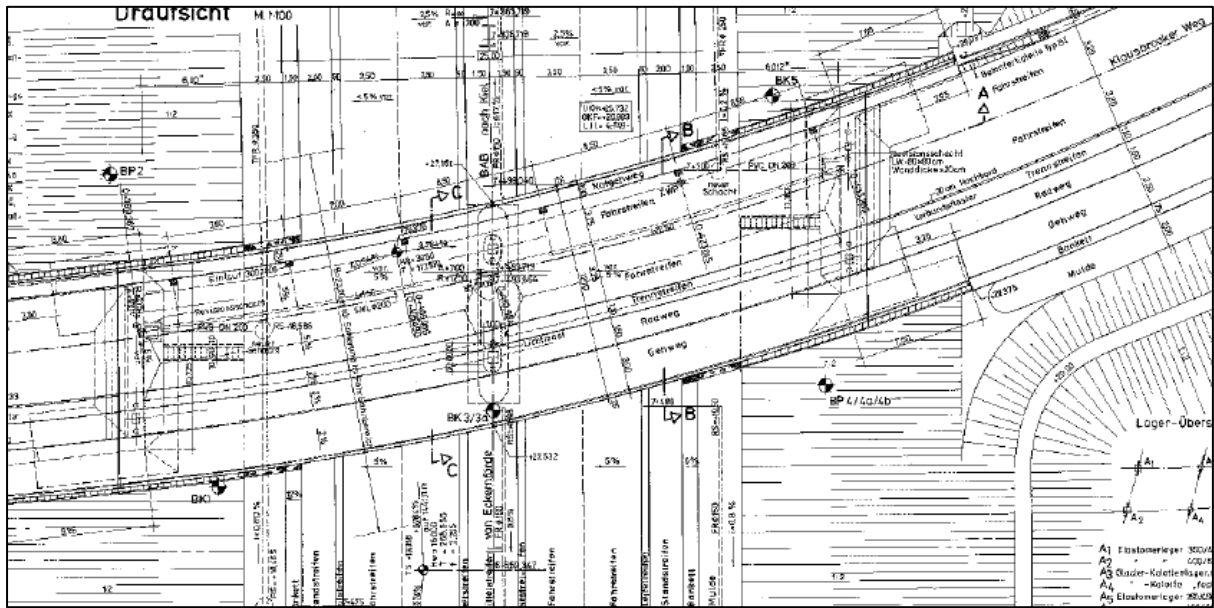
Draufsicht Bestandsbrücke Torfmoorkamp
